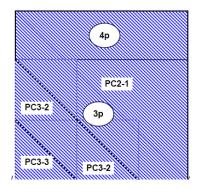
Esquema de porches, corredores y plantas arquitectónicas
